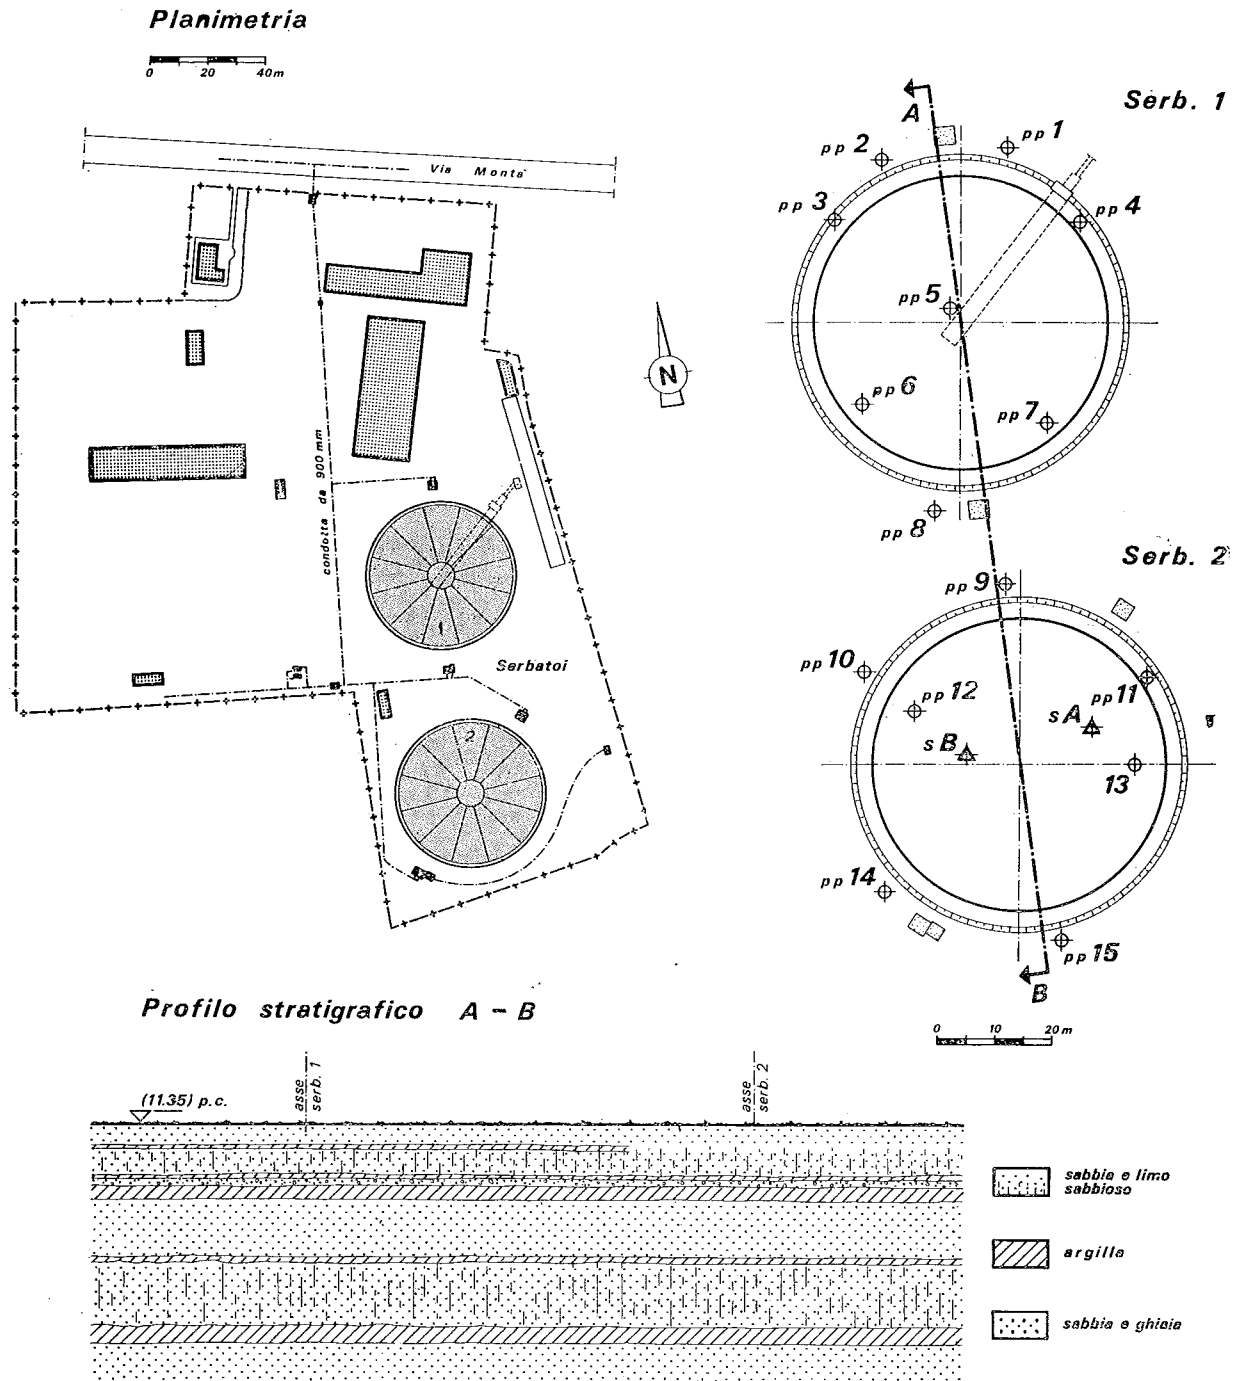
Planimetria generale del centro di Montà. Planimetria dei serbatoi con relativi sondaggi penetrometrici e sezione stratigrafica tipo.
